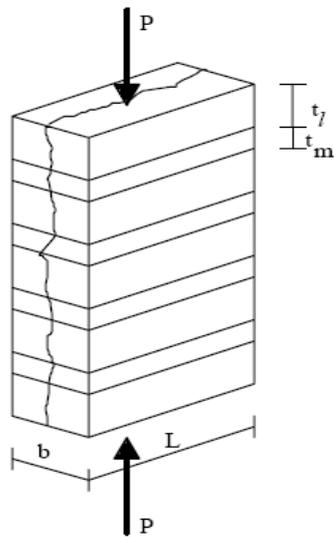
Mecánica típica de falla de la mampostería a la compresión
